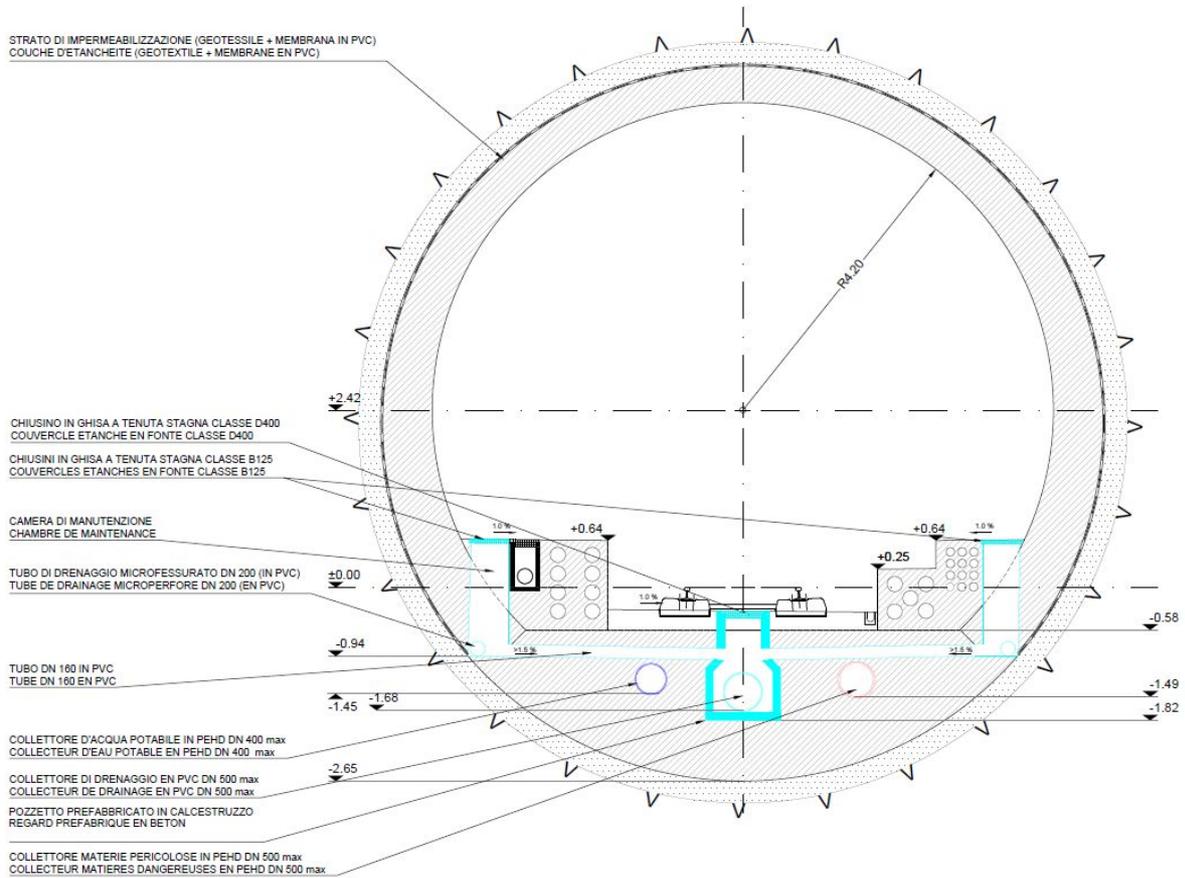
Sezione tipo del drenaggio delle acque freatiche per scavo con TBM aperta
